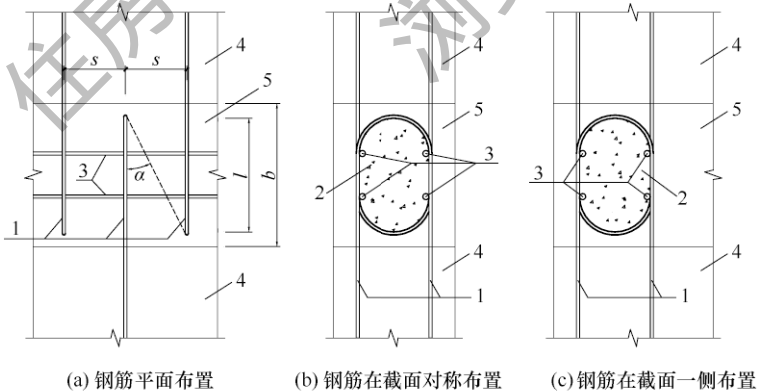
U 形钢筋交错布置现浇混凝土接缝构造示意
